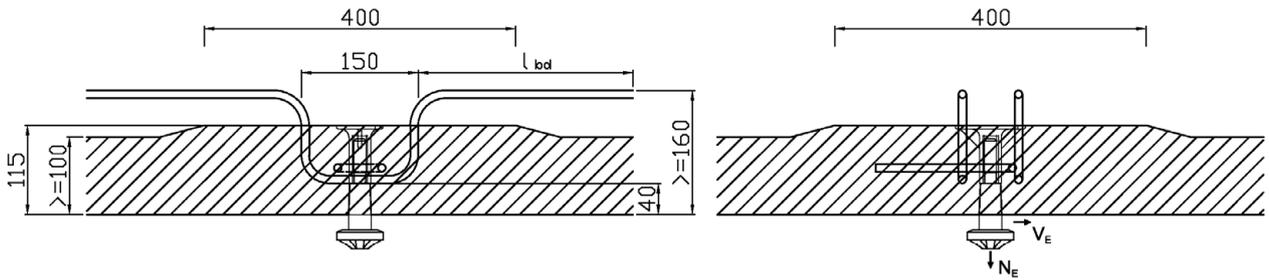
Einbauzustand im Fertigteil vor der Ortbetonergänzung
